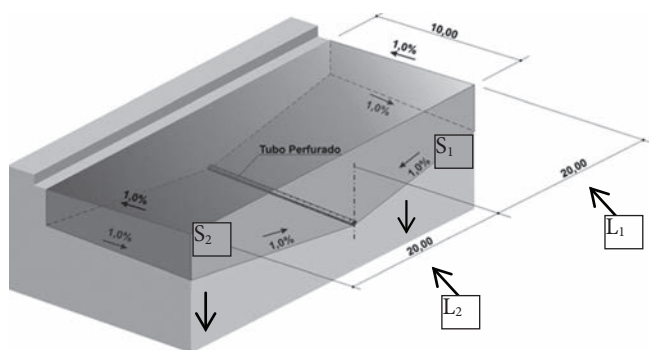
Croqui esquemático da situação adotada - via local com 10 m de largura
